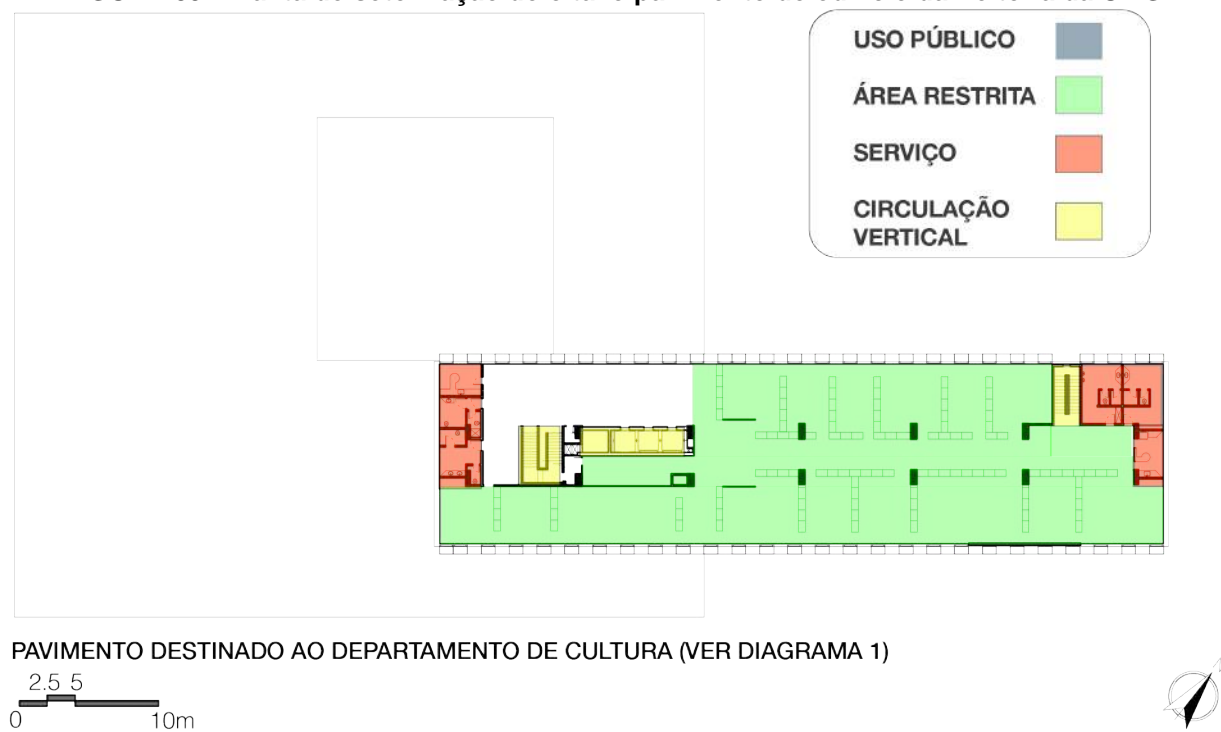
Planta de setorização do oitavo pavimento do edifício da Reitoria da UMG.
